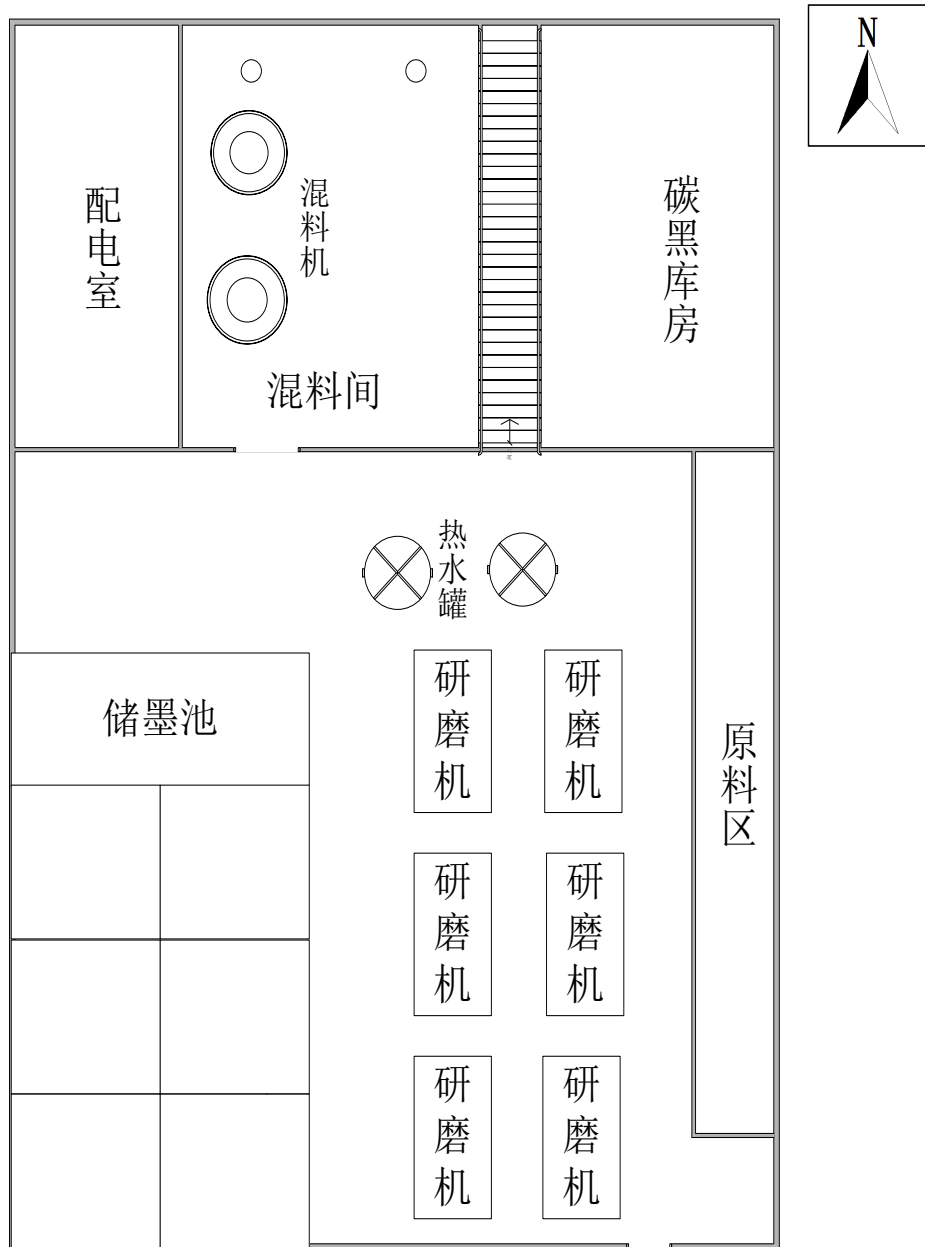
项目平面布置图（地下 1 层平面布置图）
